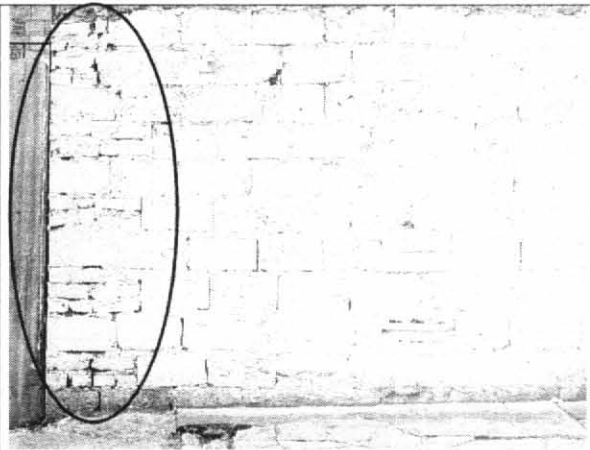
Deficiente calidad de construcción del muro de cerramiento en fachada.
